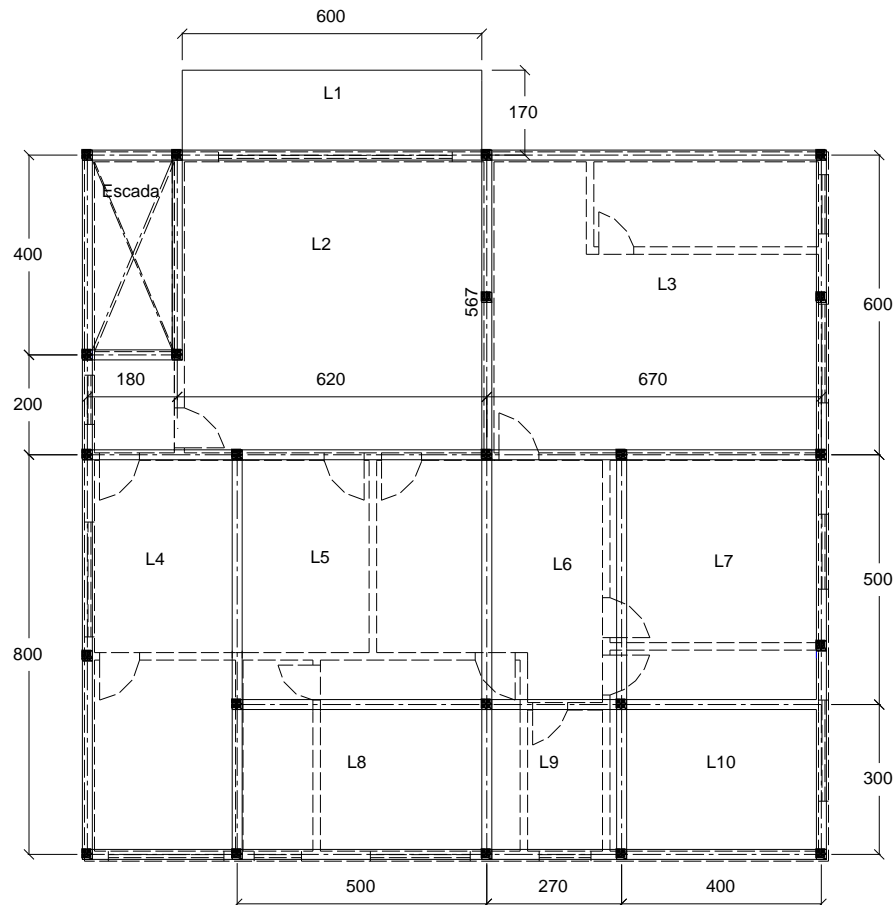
Paredes sobrepostas na planta de fôrma da estrutura.
